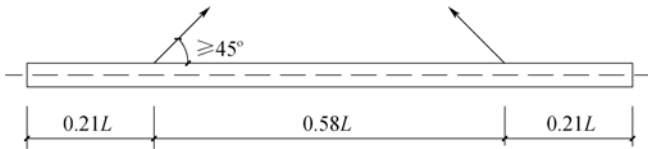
长度不大于 15m 的预应力混凝土桩吊点位置
